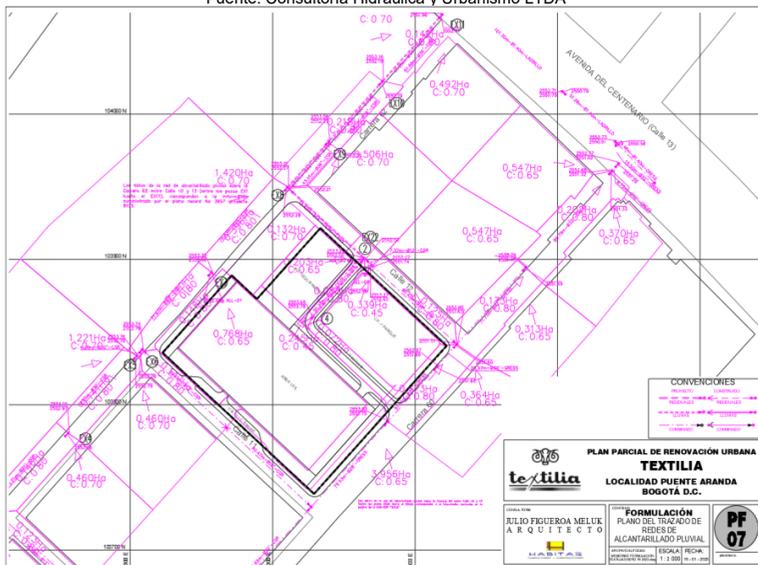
PF 07 Trazado de Redes de Alcantarillado Pluvial
